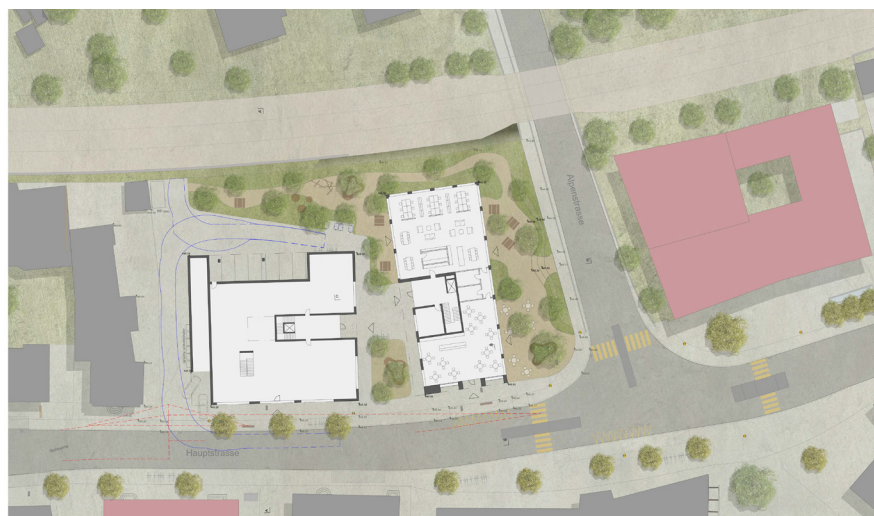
Grundrisse Erdgeschoss mit Aussenraumgestaltung, Schleppkurven und Gewässer-raum (Quelle: SDM - ARCHITEKT und grünwerk 1 landschaftsarchitekten ag, Juni 2023)
